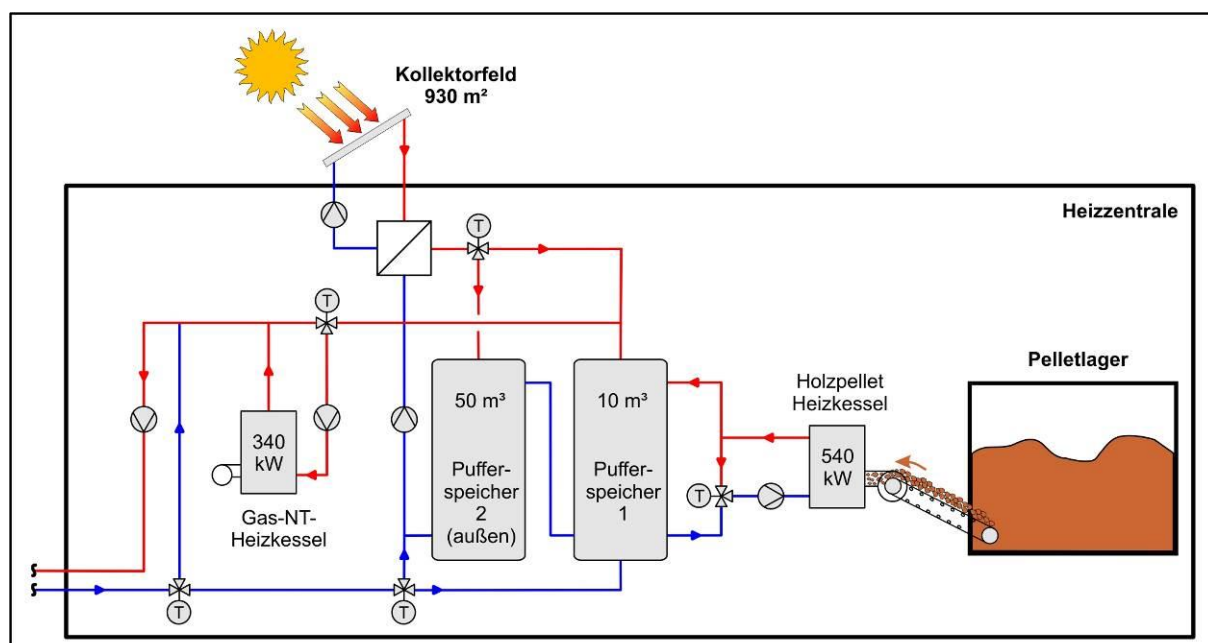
Anlagenschema Variante 2 – Holzpelletkessel mit Solaranlage 930 m²
